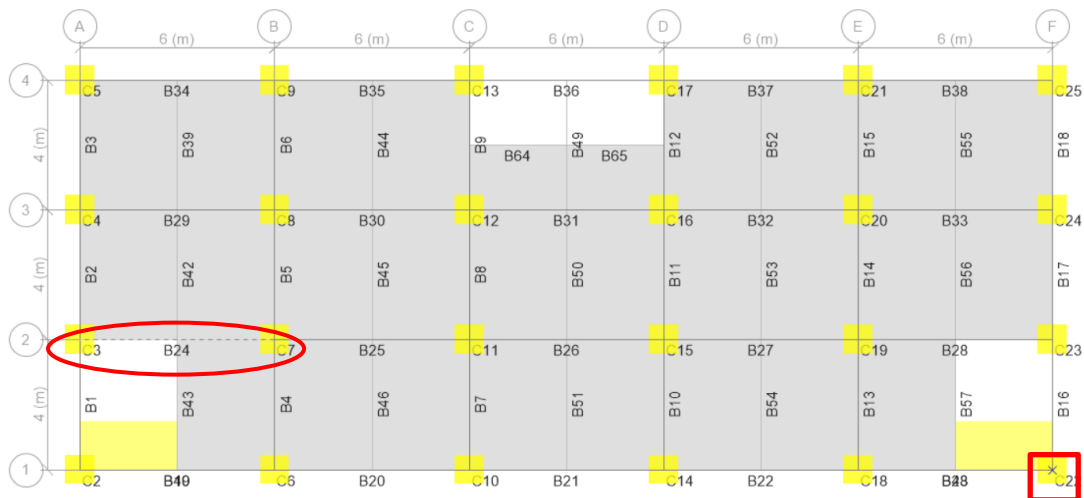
Potongan rangka struktur gedung kantor 10 lantai.
